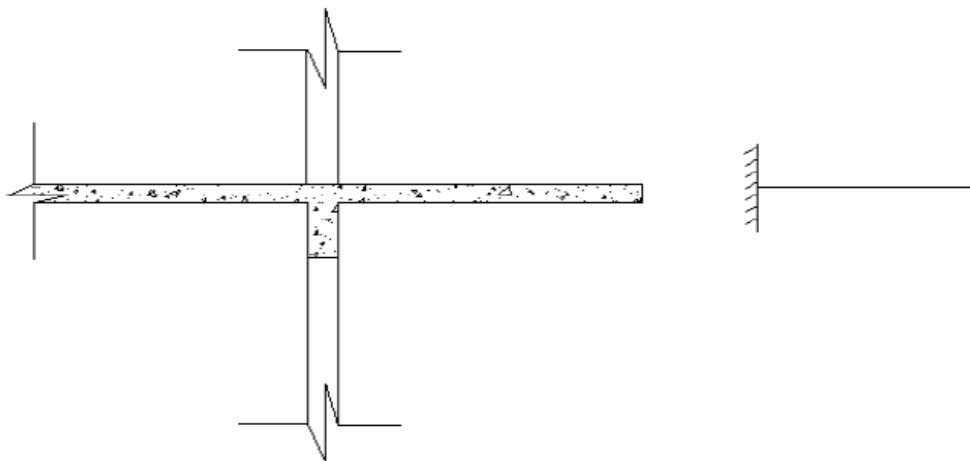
Laje em balanço com espessura constante engastada na laje interna
